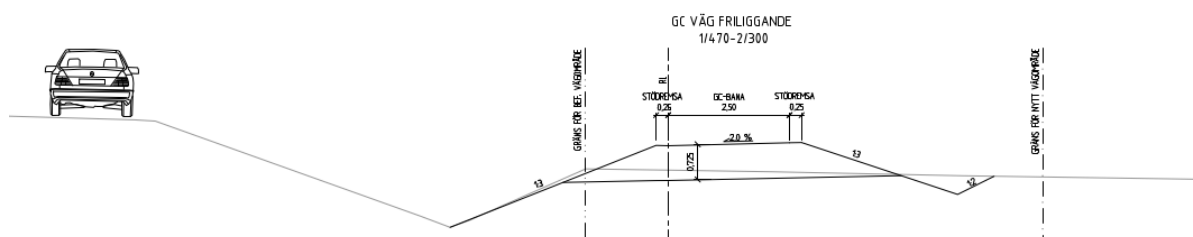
Typsektion separering dike, överbyggnad 325 mm
